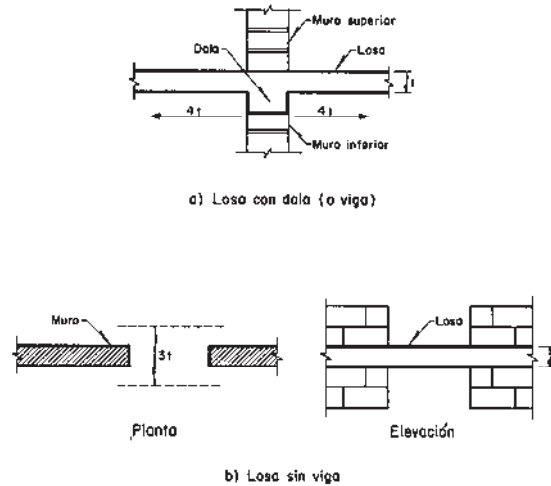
Ancho efectivo de losa para cálculo de momento de inercia de la viga de acoplamiento
